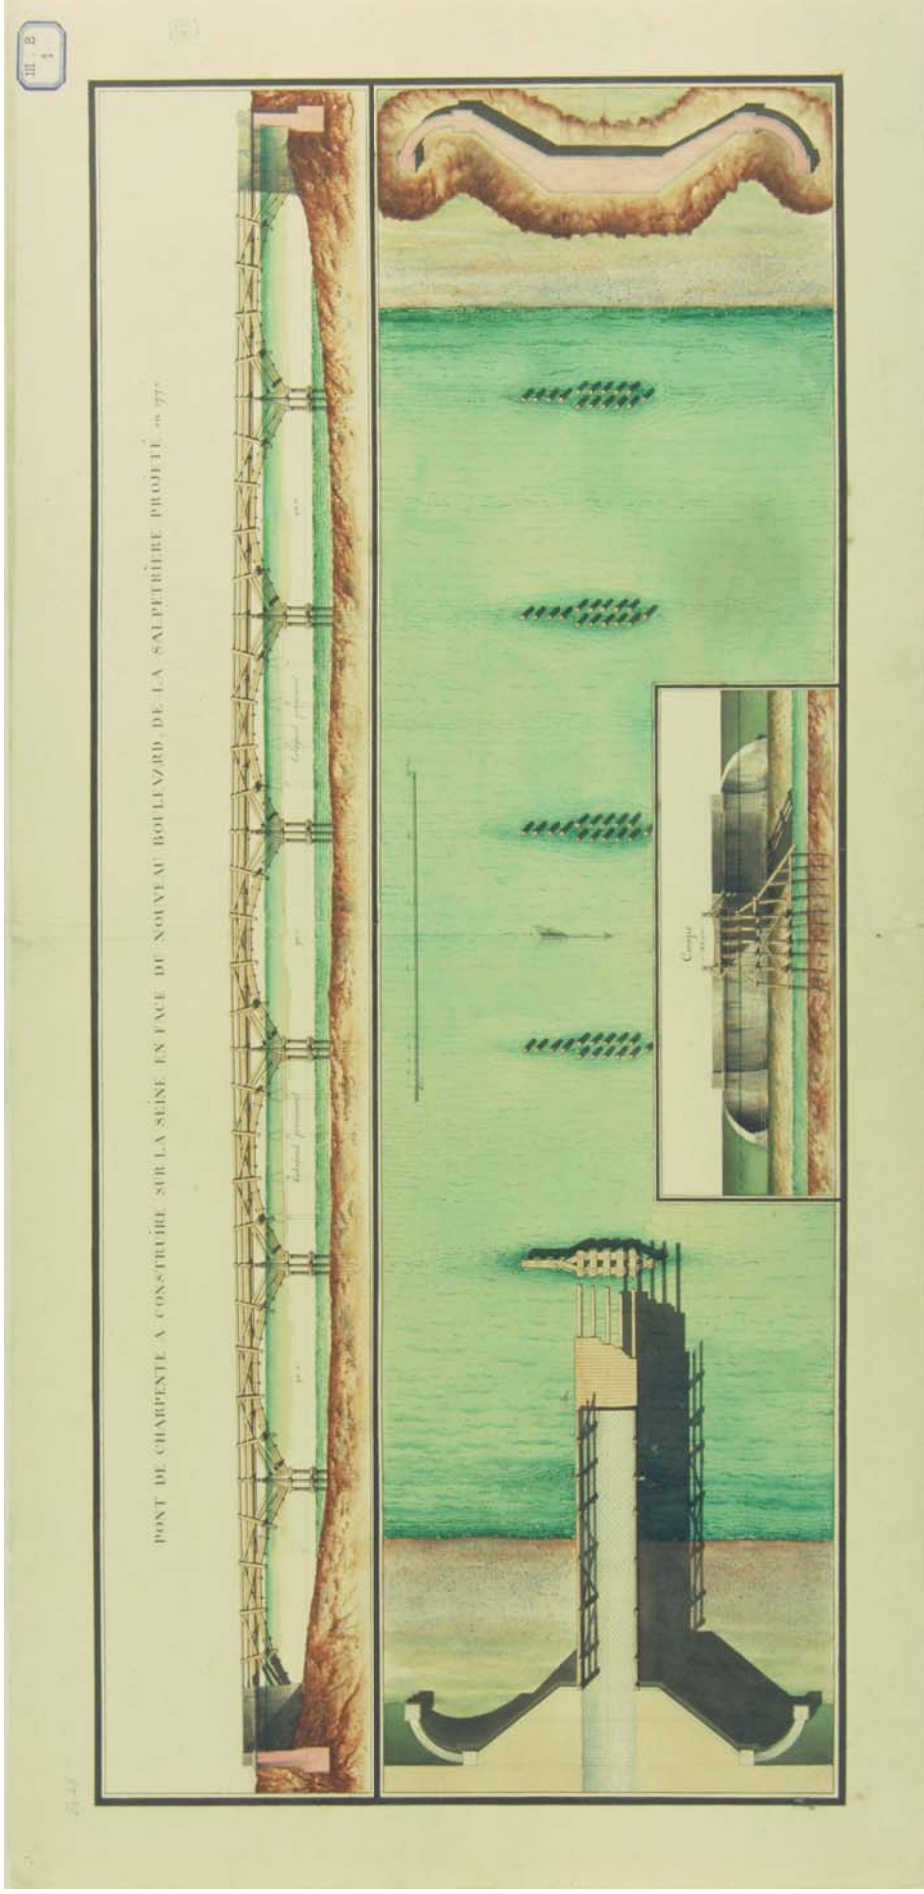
DG 793 – Pont de charpente à construire sur la Seine en face du nouveau boulevard de la Salpêtrière projeté en 1773. Concours architecture. 1773
